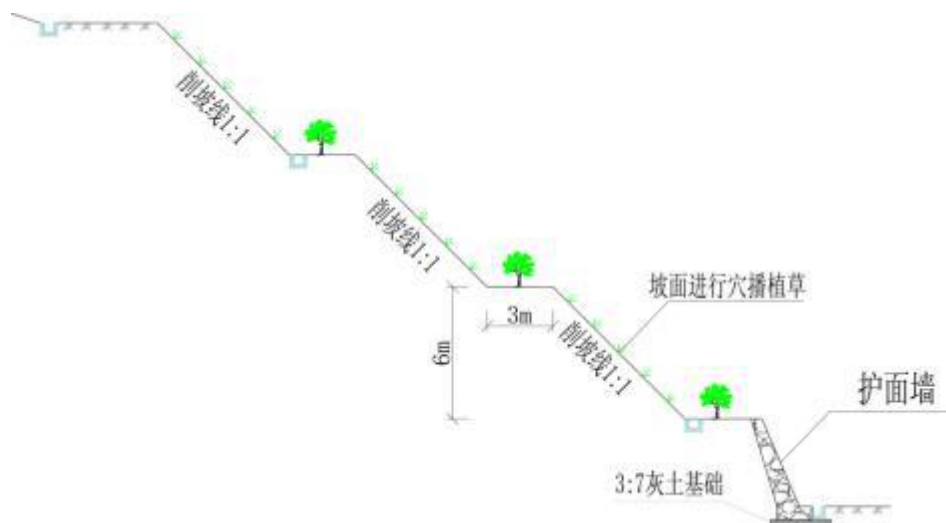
削坡、护面墙及坡面绿化断面示意图(单位:cm)
